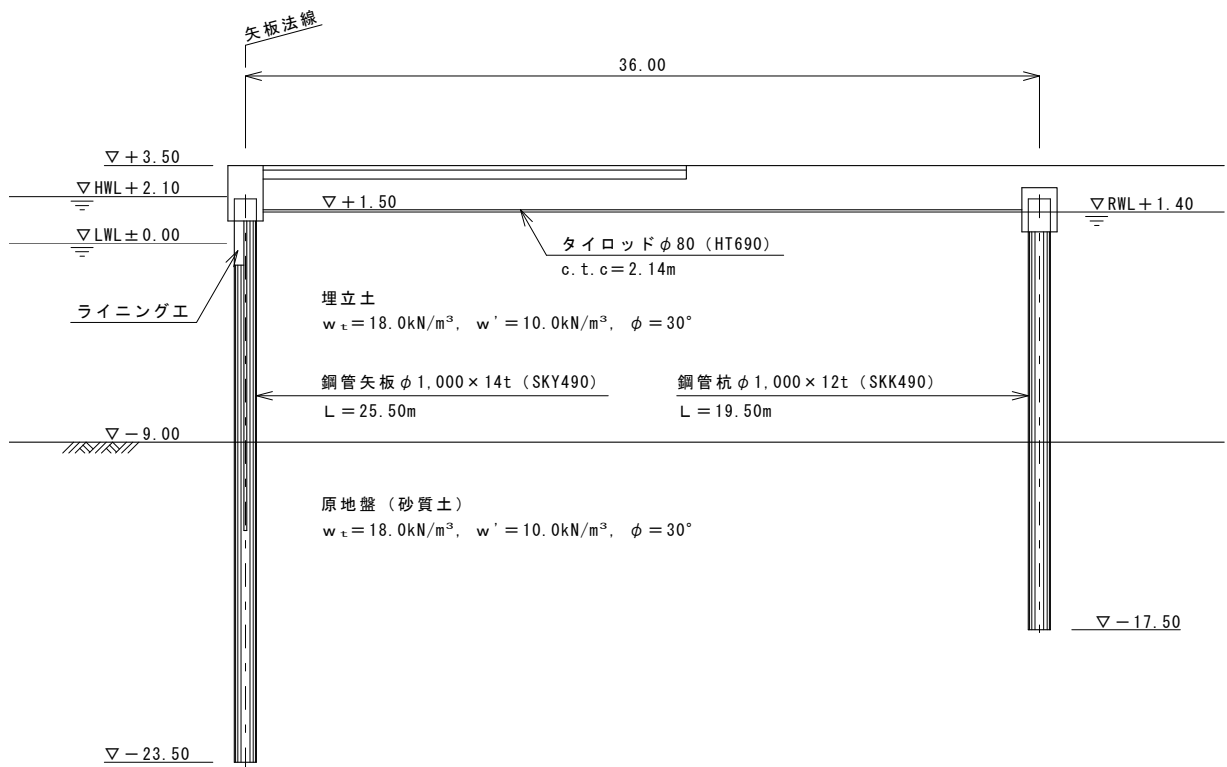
控え式矢板岸壁標準断面図 (参考)
